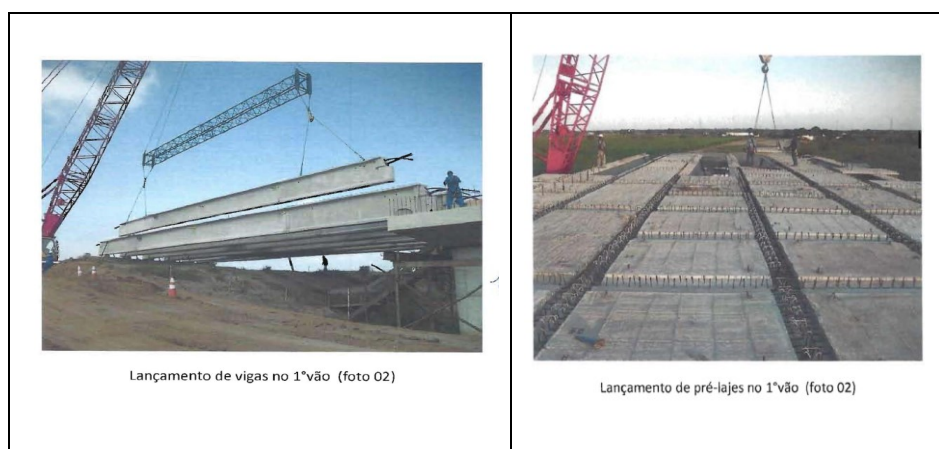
Lançamento de vigas e pré-lajes com guindaste
